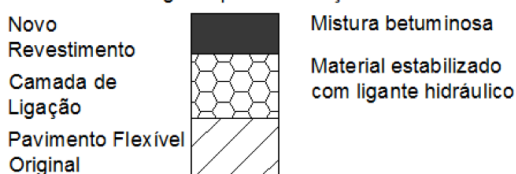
tipos de pavimento semi-rígido (BALBO, 2007, p.52)
